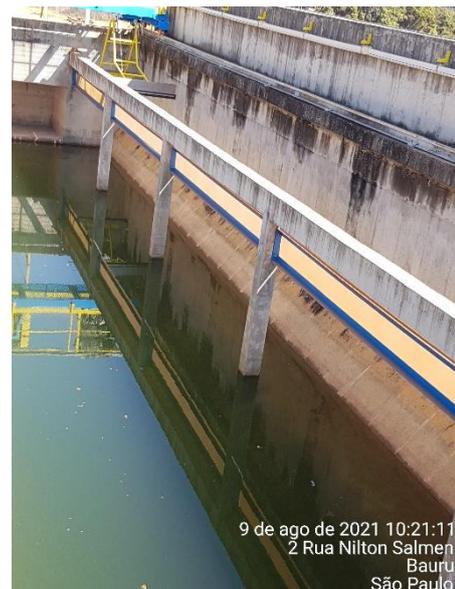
Vigas com fissuras (Data da imagem: 09/08/2021)
